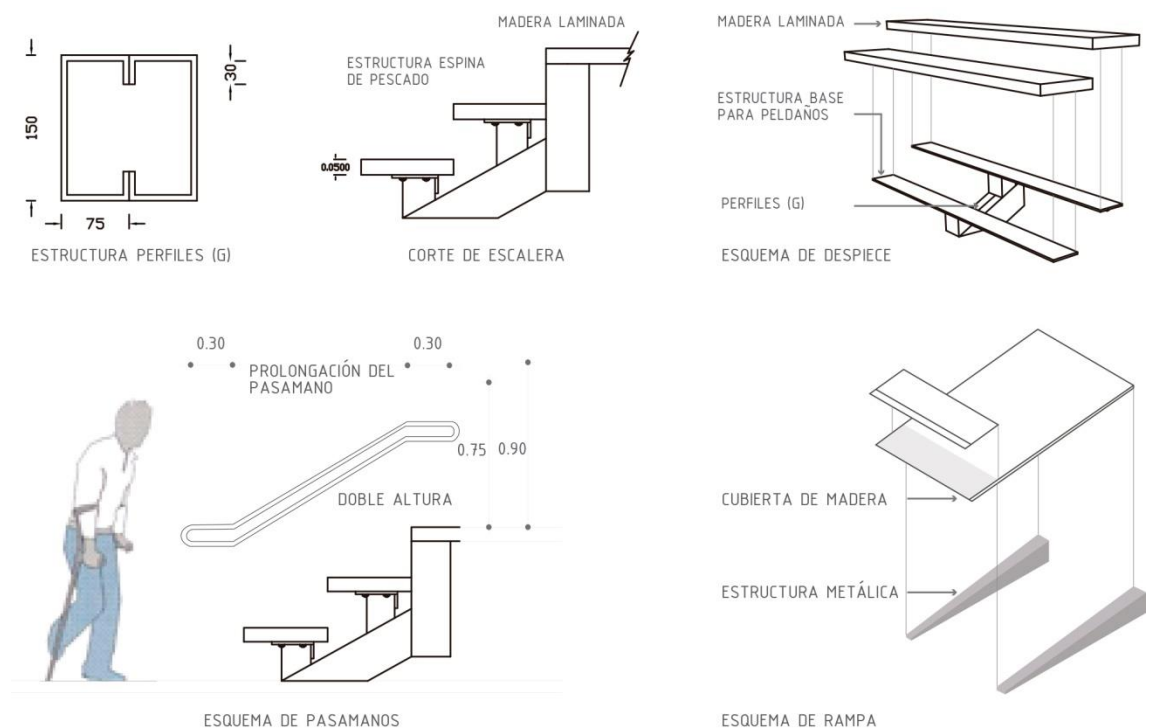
Detalle de Escalera, Rampa y Pasamanos
